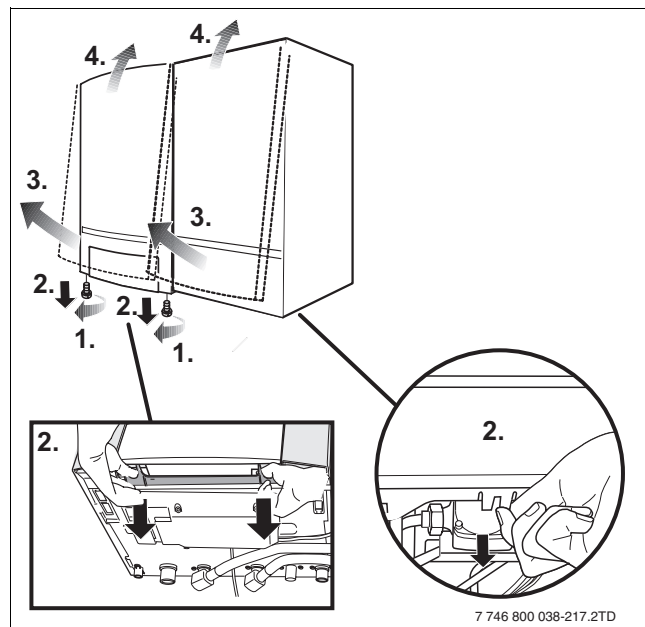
Демонтаж облицовки бака-водонагревателя с послойной загрузкой
